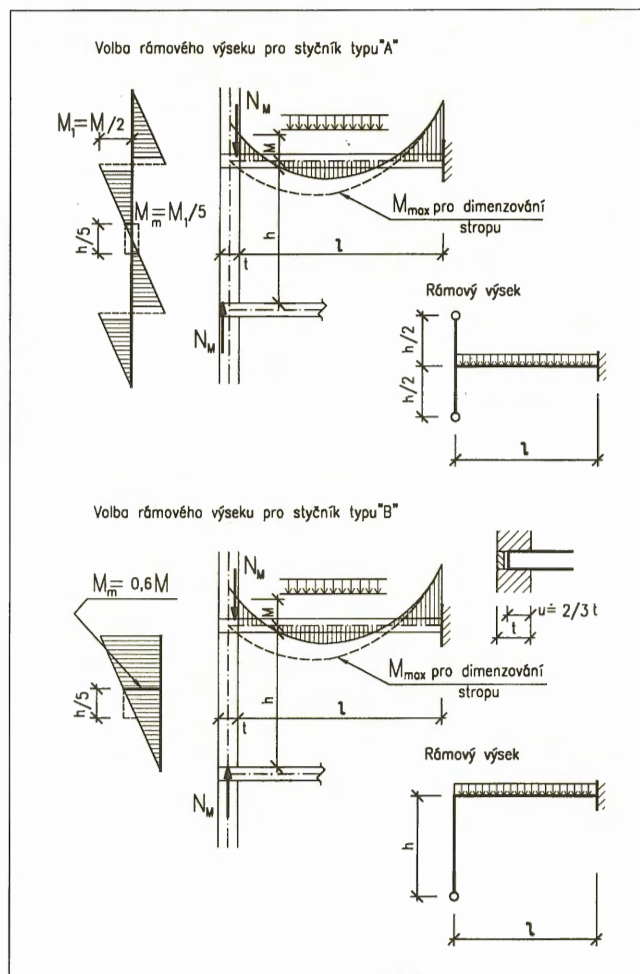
Statická schémata v závislosti na typu styčníku při tuhých stropěch / Structural schemes related to the types of joints with stiff floors
